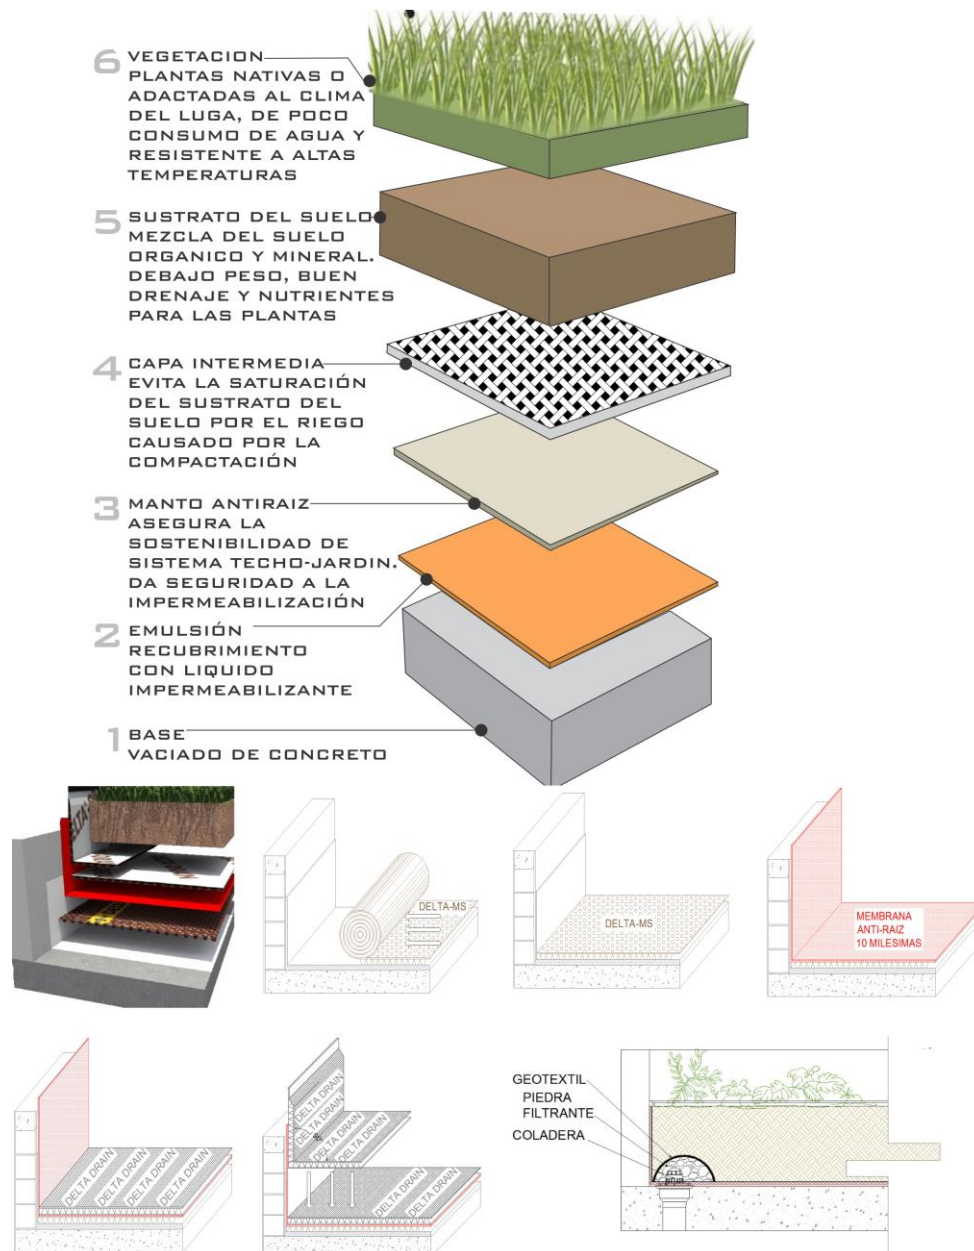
detalle de cubierta verde Sistema Flotado Delta
